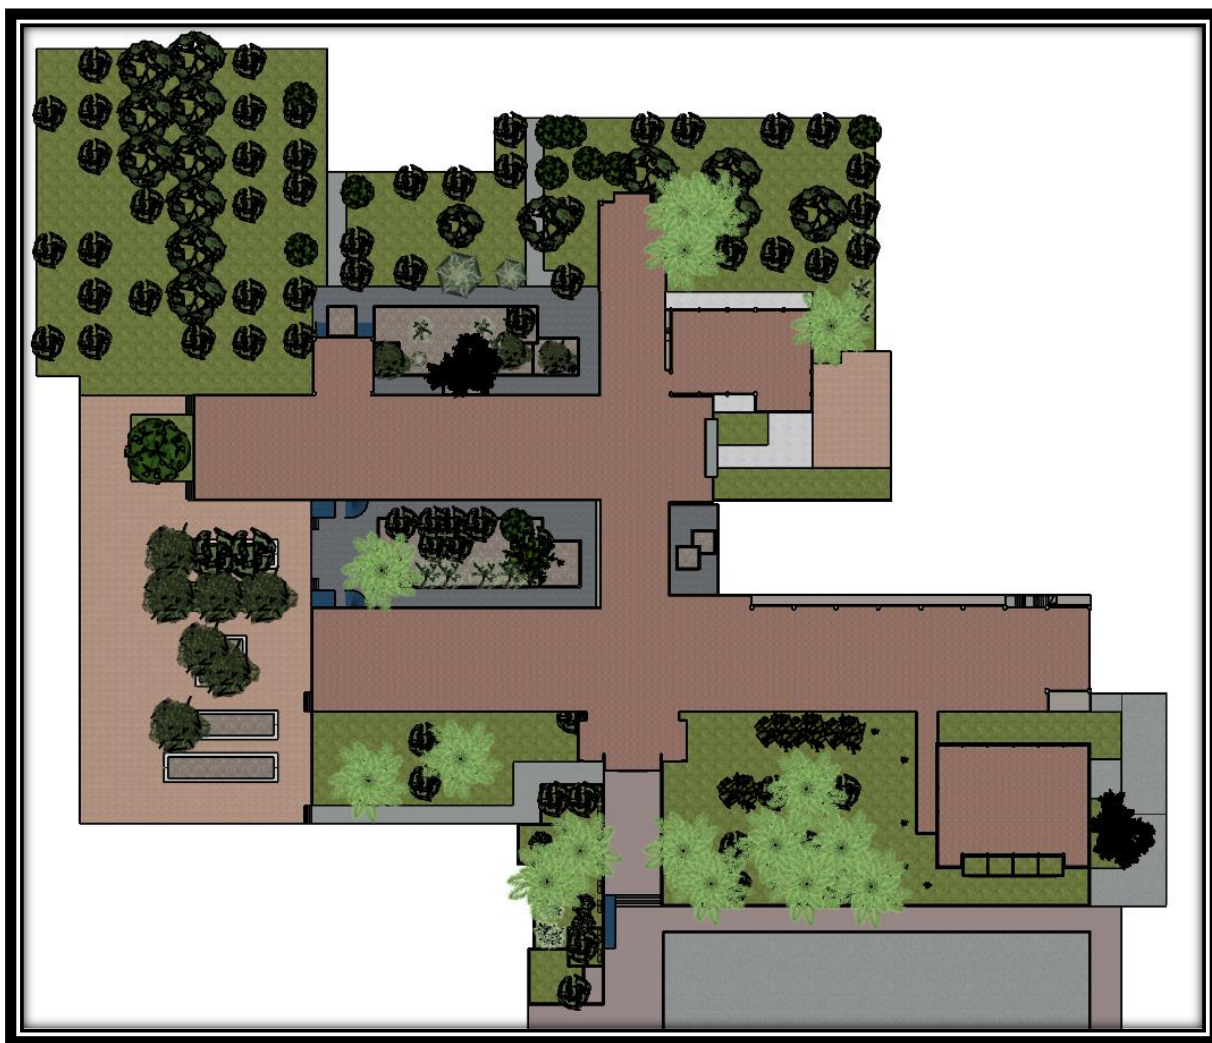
Planta de Conjunto de la FIC - Vegetación y Áreas Verdes. Elaboración Propia
